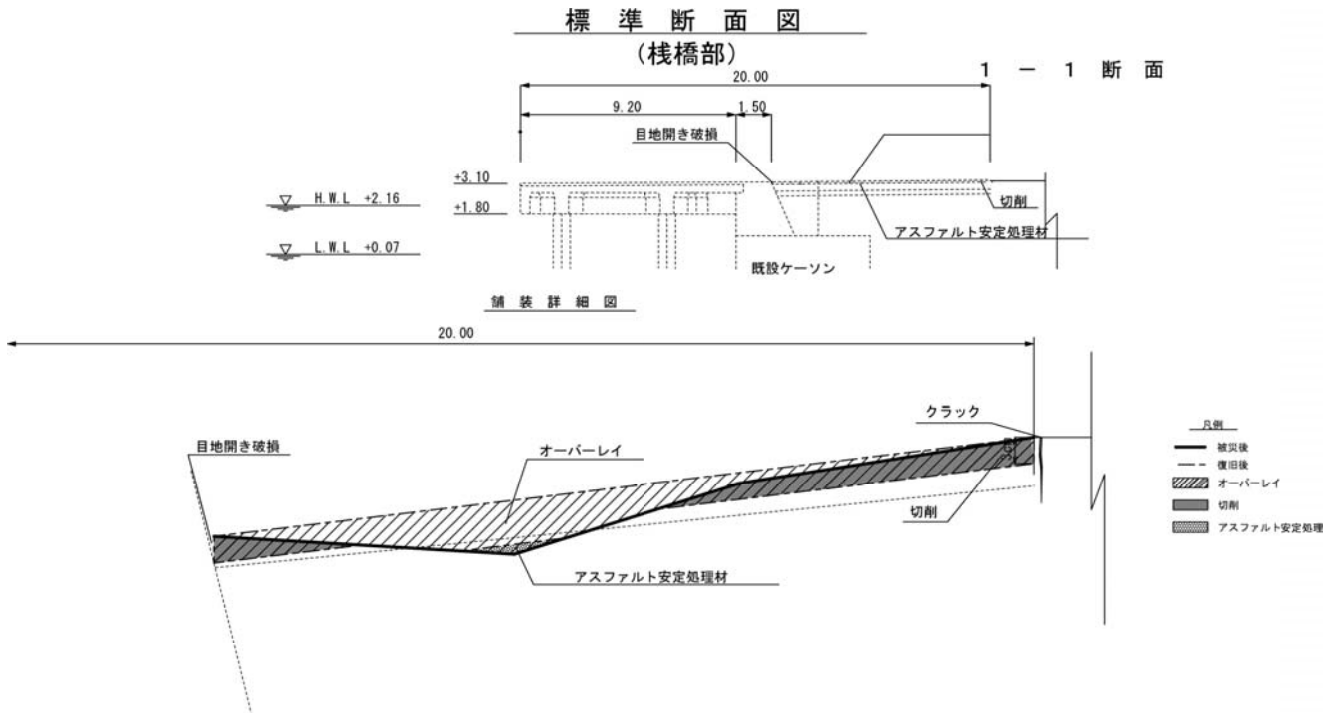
中央埠頭西側-10m岸壁・栈橋の被災・復旧標準断面図
